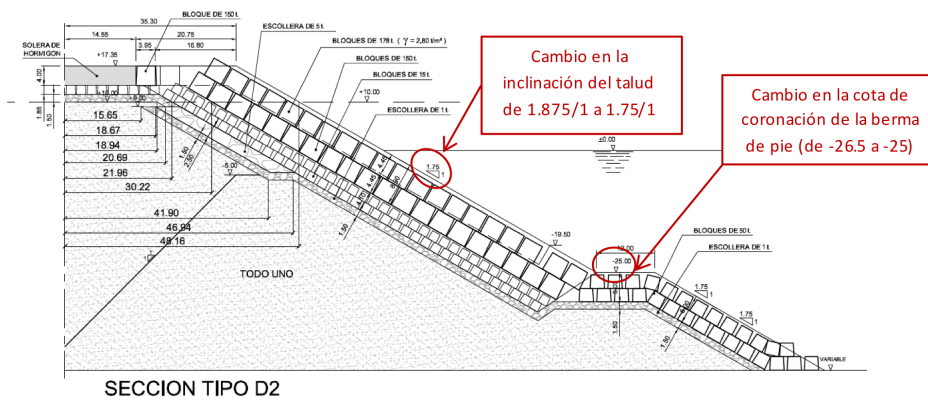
Sección tipo en el morro (bloques de 178 Tn, talud 1.75H:1V)
